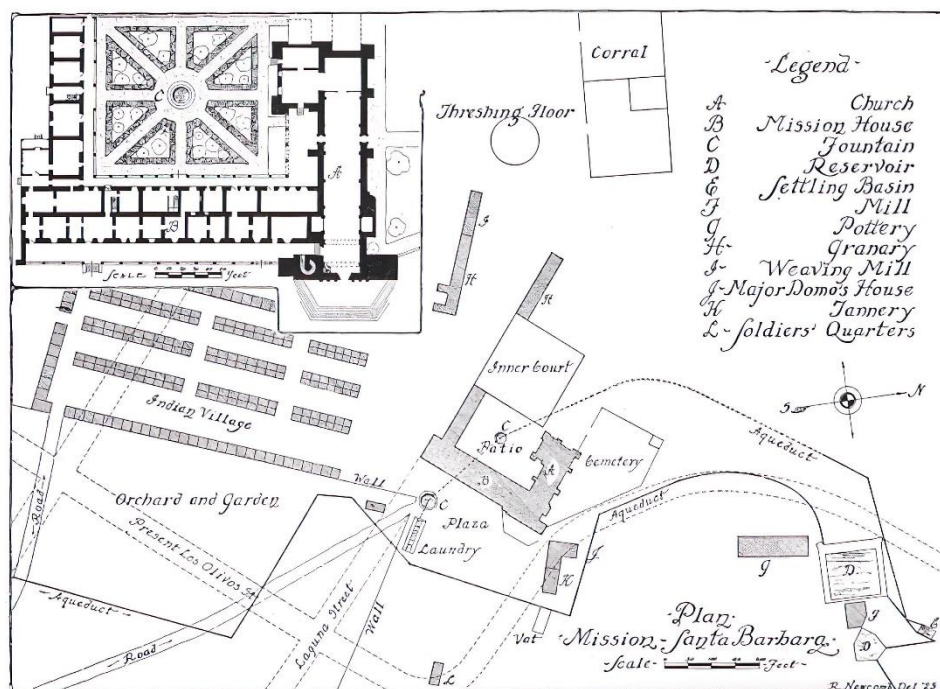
Plano de la Misión Santa Bárbara con detalle del cuadrilátero y jardines.
